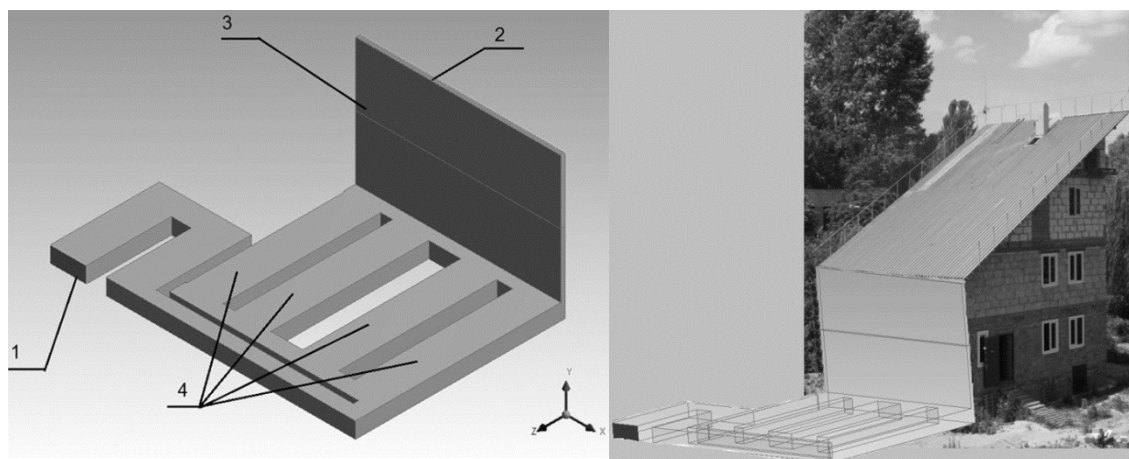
а* – Розрахункова схема. *б* – Розташування коробів повітряно-грунтового теплообмінника біля фасадних стін енергоефективного будинку.
